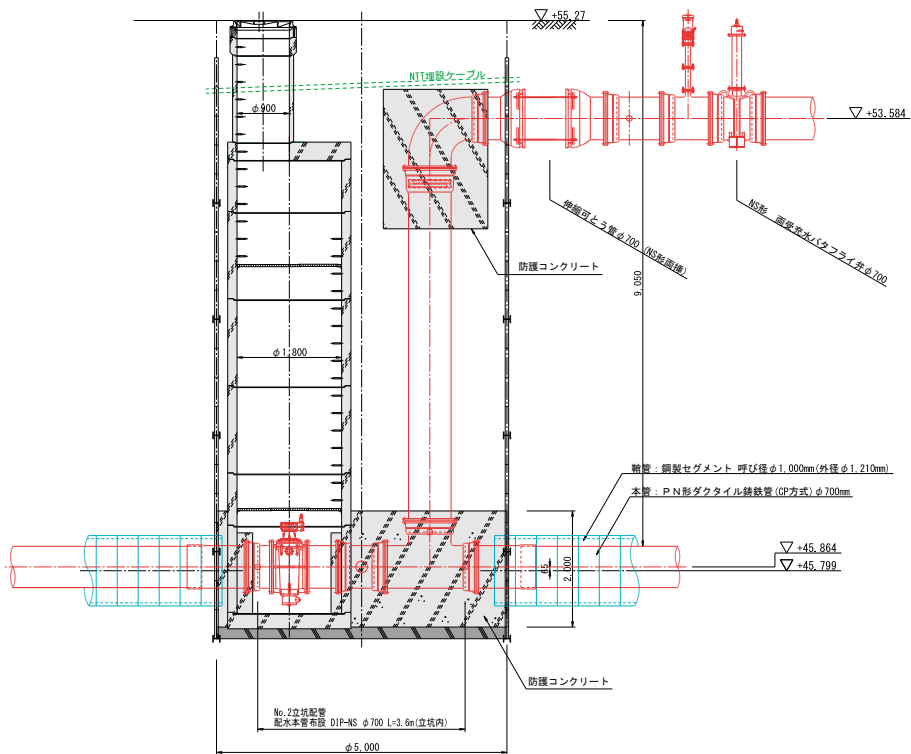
2 No.2 中間立坑 (A - A) 断面図
